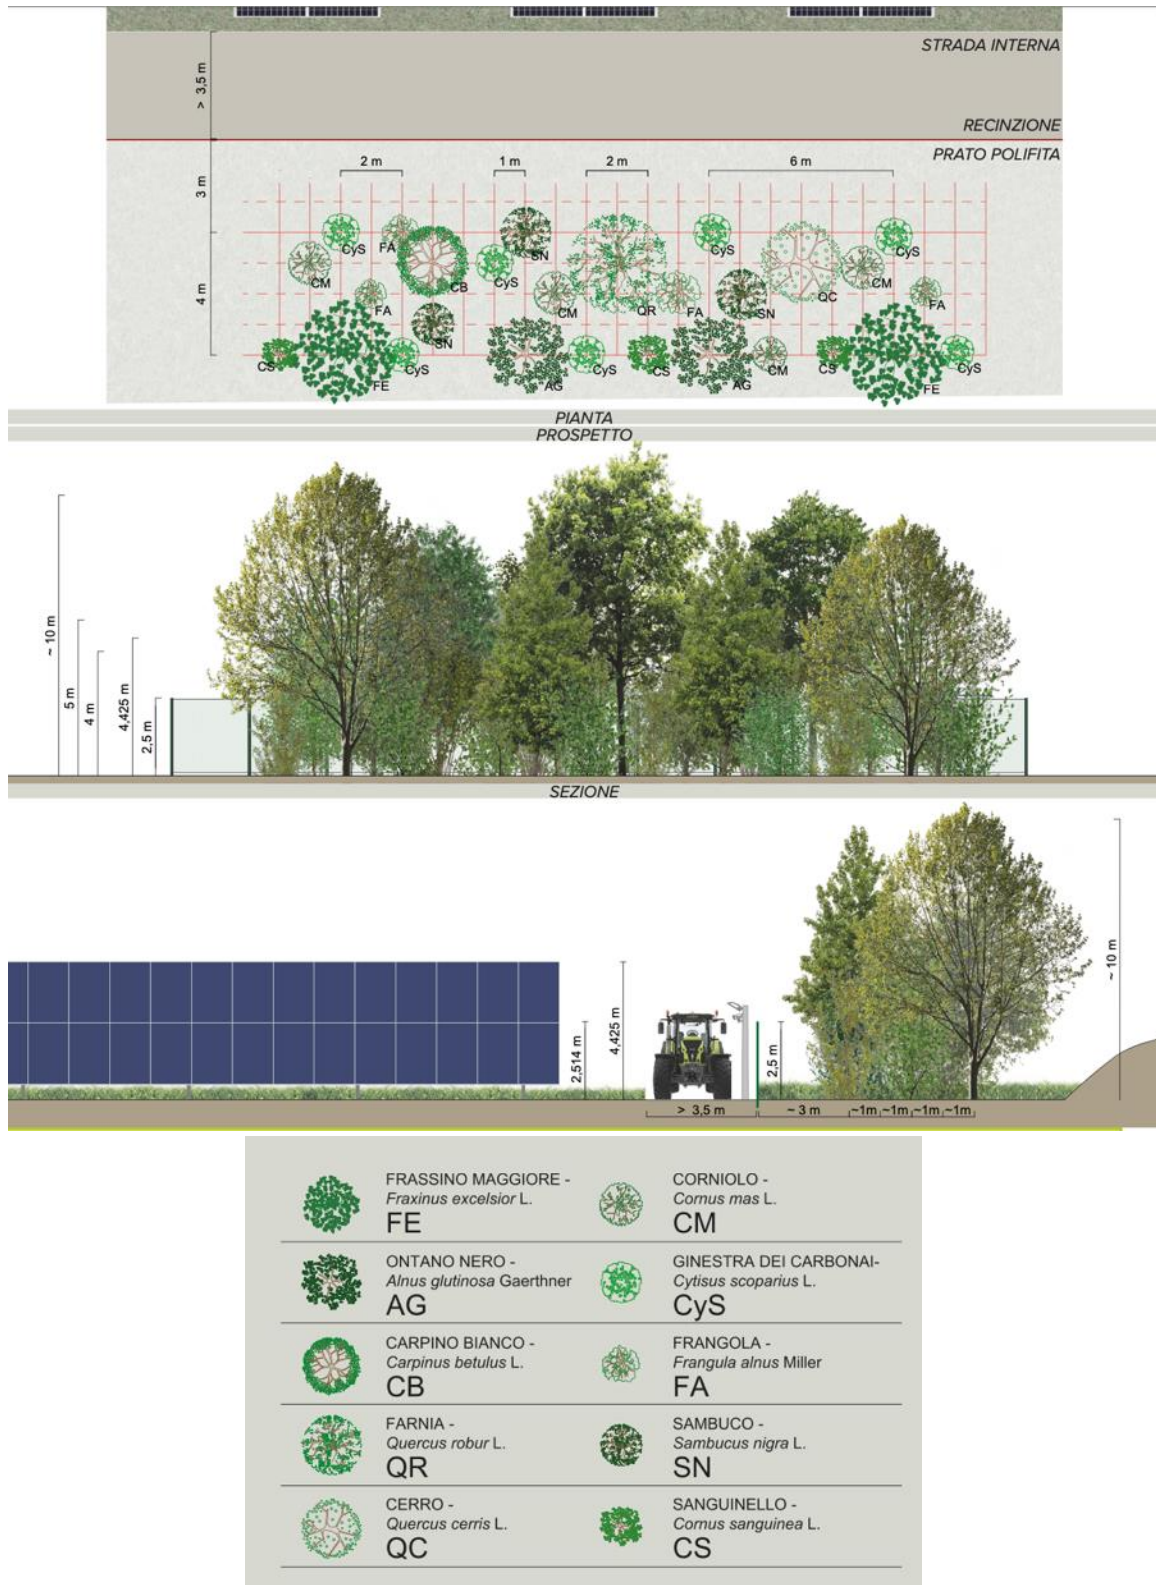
Sesto di impianto, prospetto e sezione delle fasce vegetate di Tipo 1.
